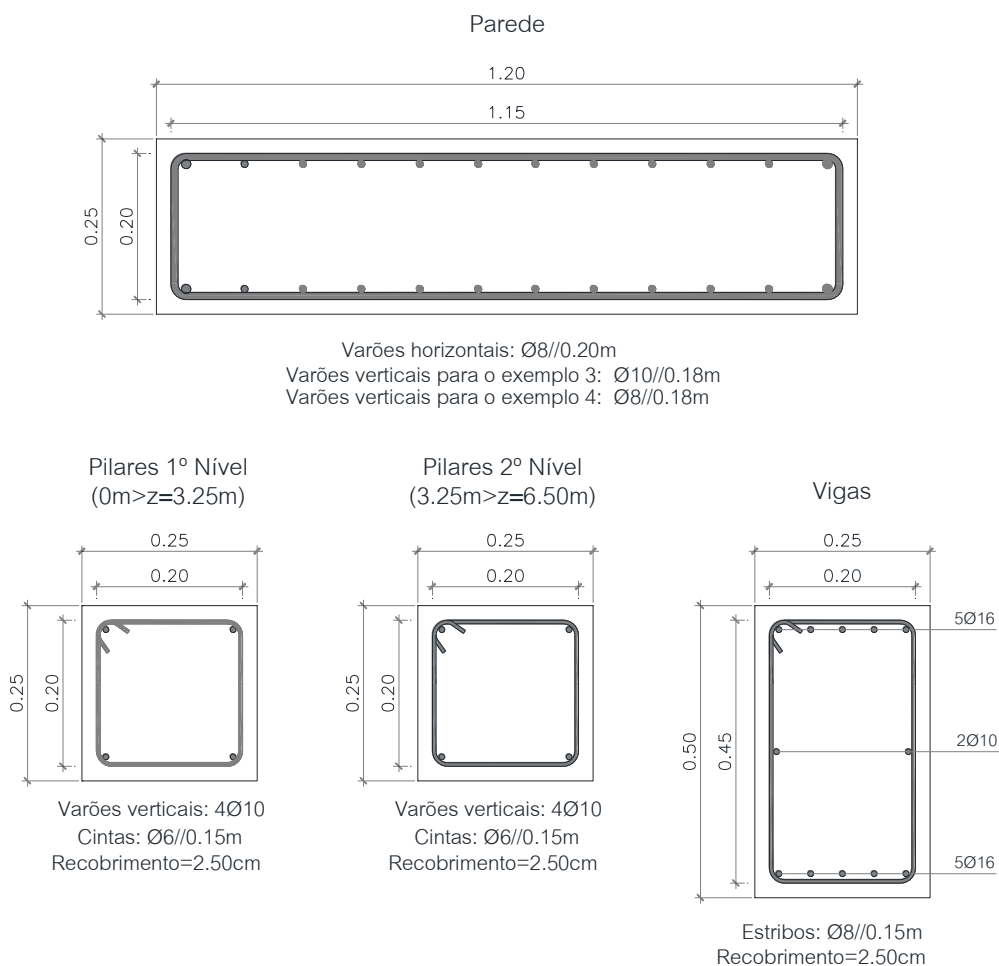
Pormenorização de pilares, parede e vigas para os exemplos 3 e 4
